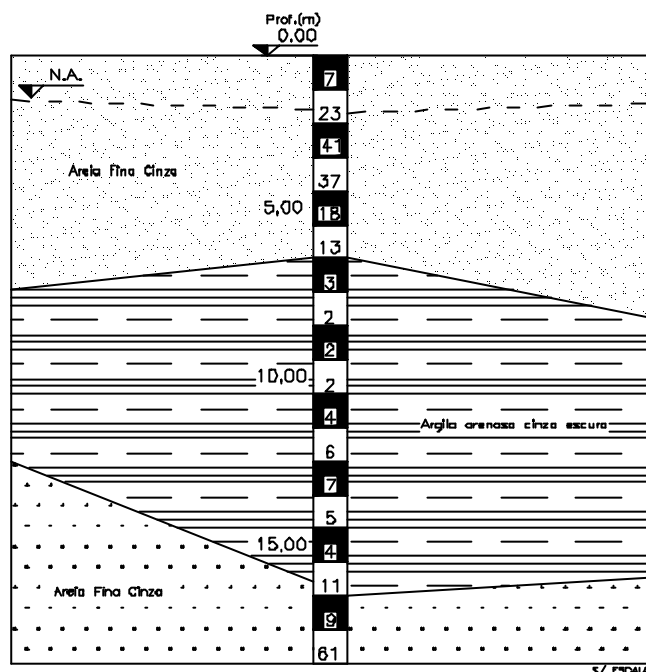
Perfil longitudinal de distribuição dos solos encontrado ao longo da R. Madre Maria Villac.
